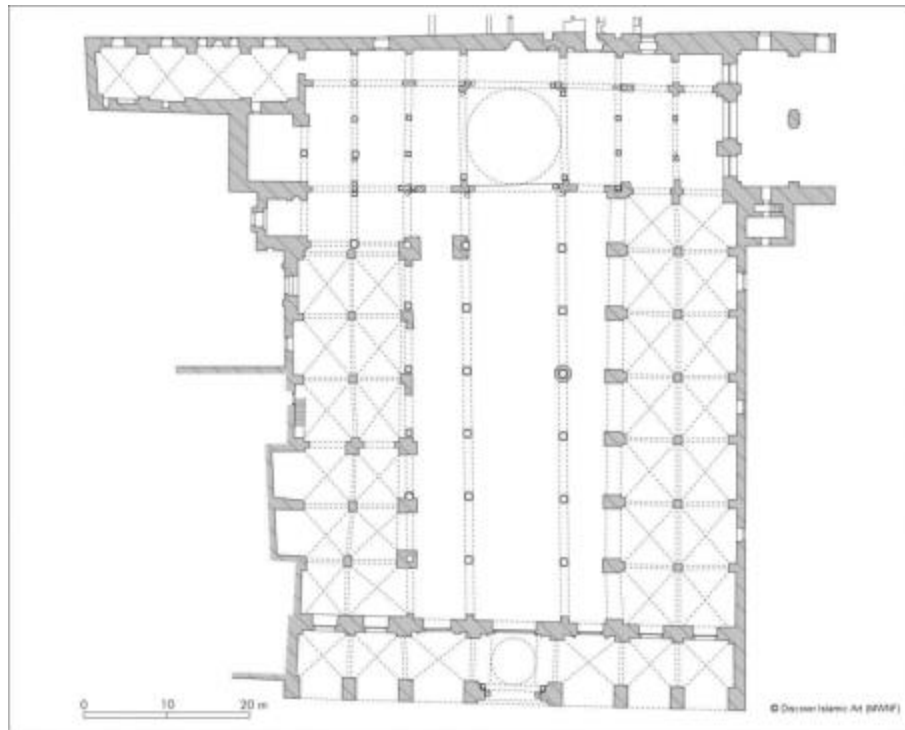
Planta de la Mezquita al-Aqsa, Jerusalén, siglo VII.
